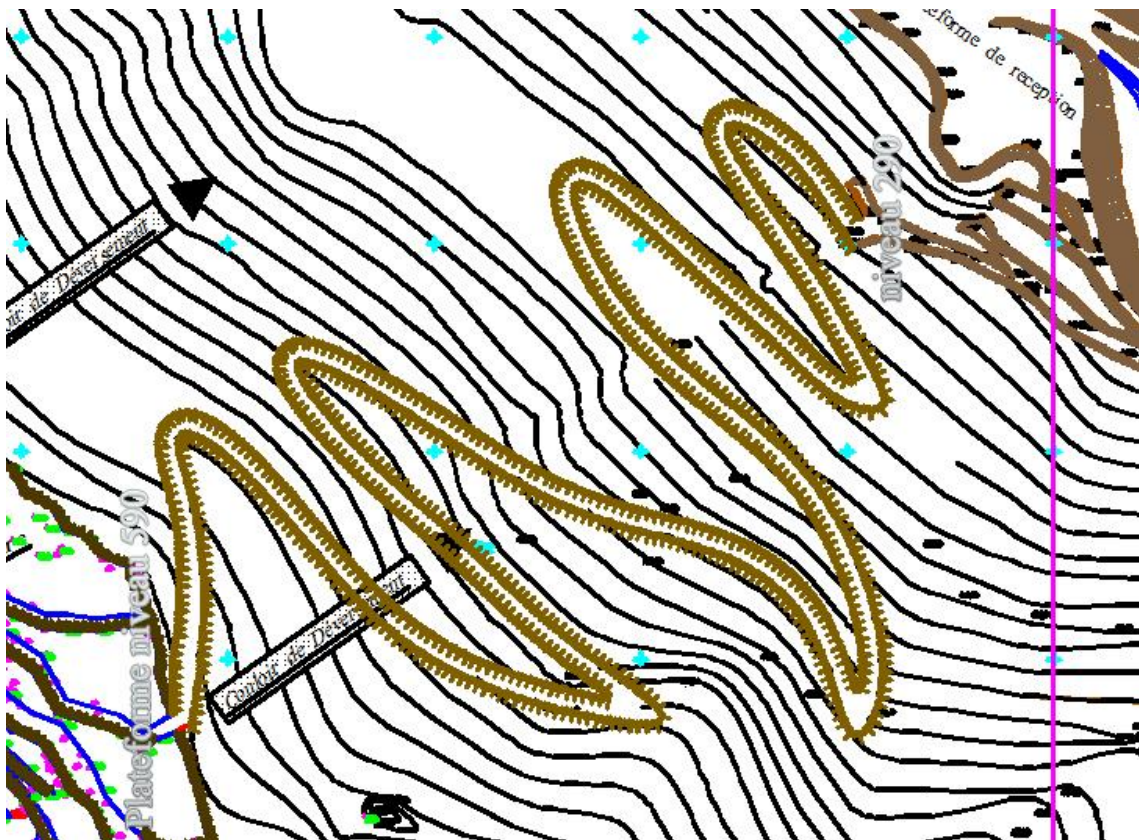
plan schématique de la piste proposé 1/1000° (voir le plan d'arpentage en annexe)
